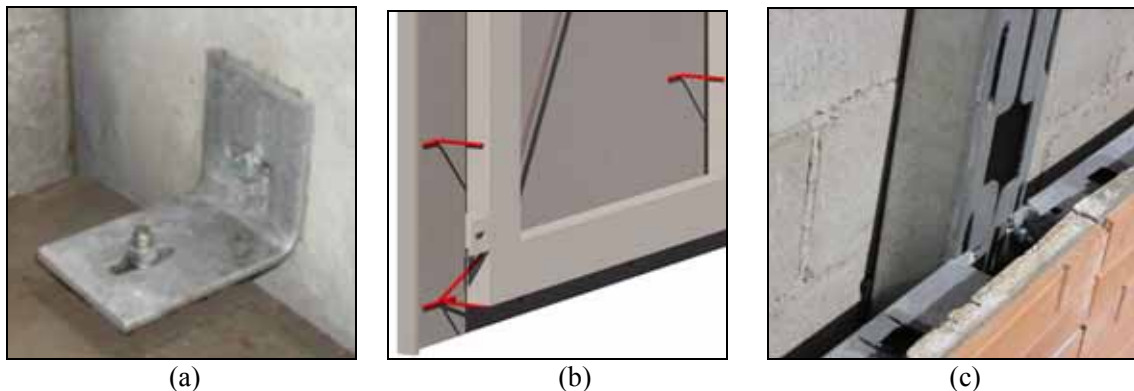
(a) Fixação painel sanduíche; (b) lado posterior do painel stud frame, mostrando em vermelho, as hastes flexíveis; e (c) fixação do painel *stud frame
